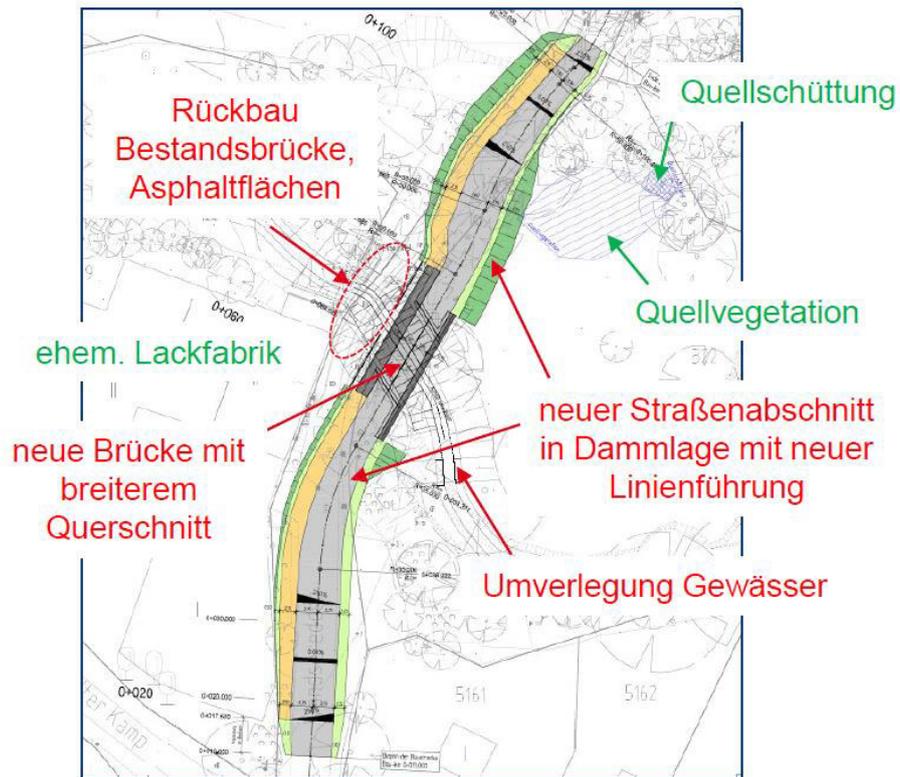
Lageplan neuer Straßenabschnitt (Auszug LOMB)
